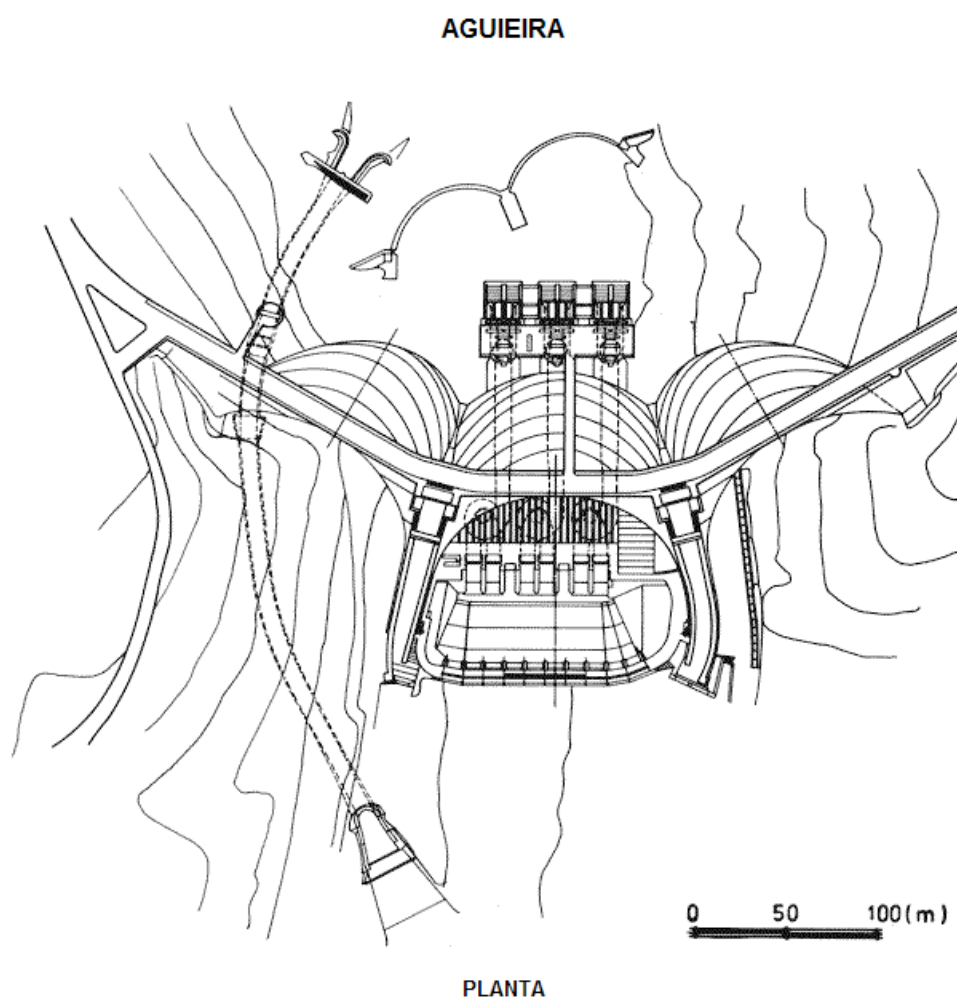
Barragem da Aguieira – Planta [4]
